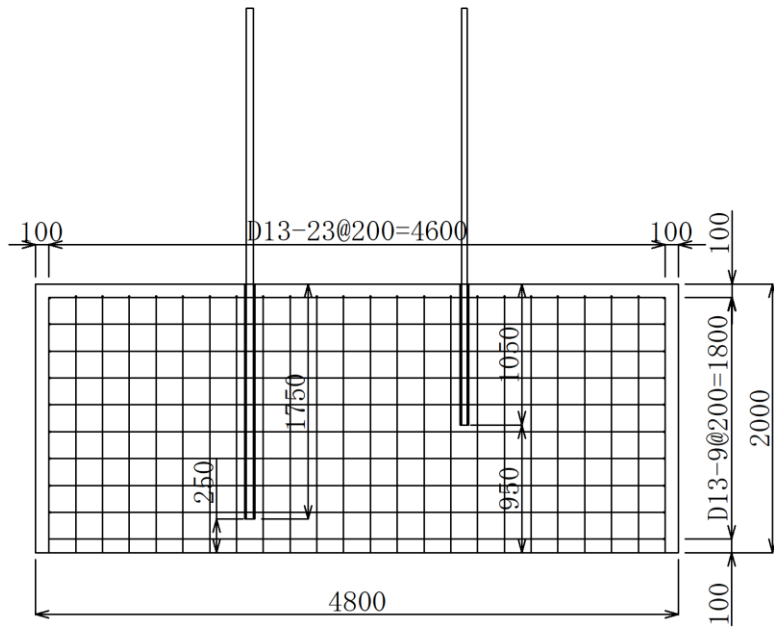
(3) 実験体①の配筋図 (B-B 断面図)
